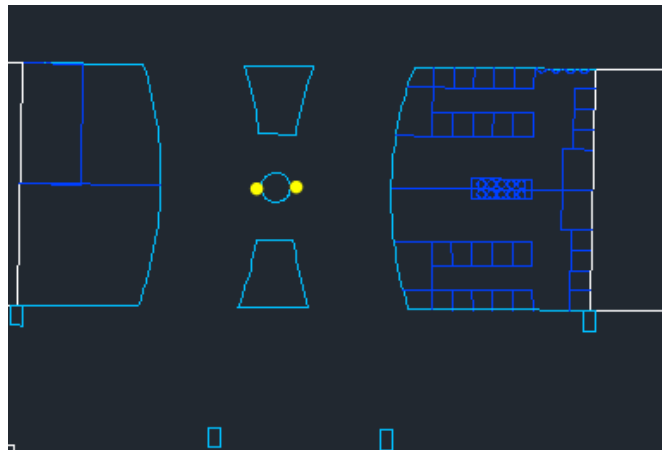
Figura XIV. Plano iluminación cruce(realizado en AutoCAD).
